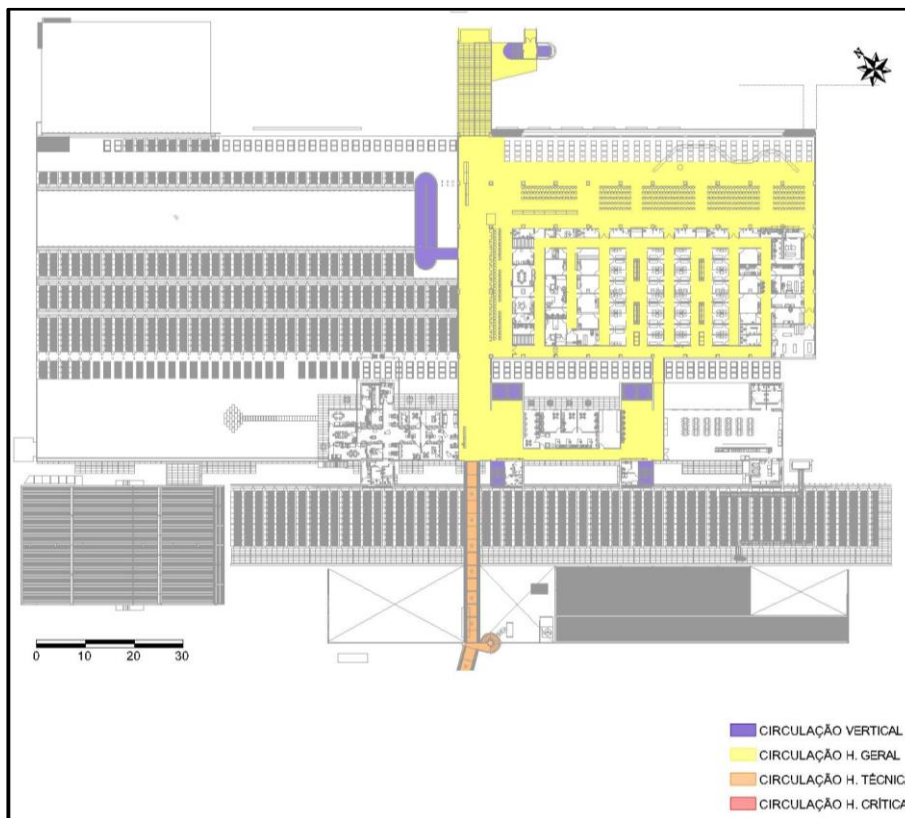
Setorização complexo principal, pavimento térreo (circulações).
